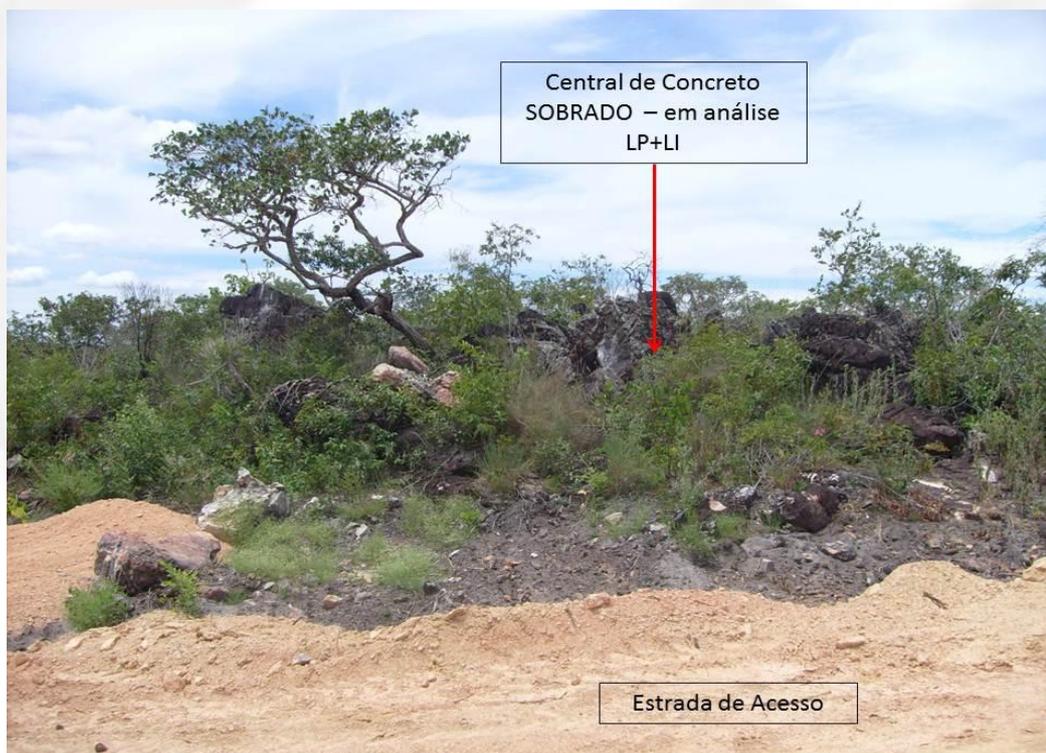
Vista frontal do local da Instalação da Central de Concreto
